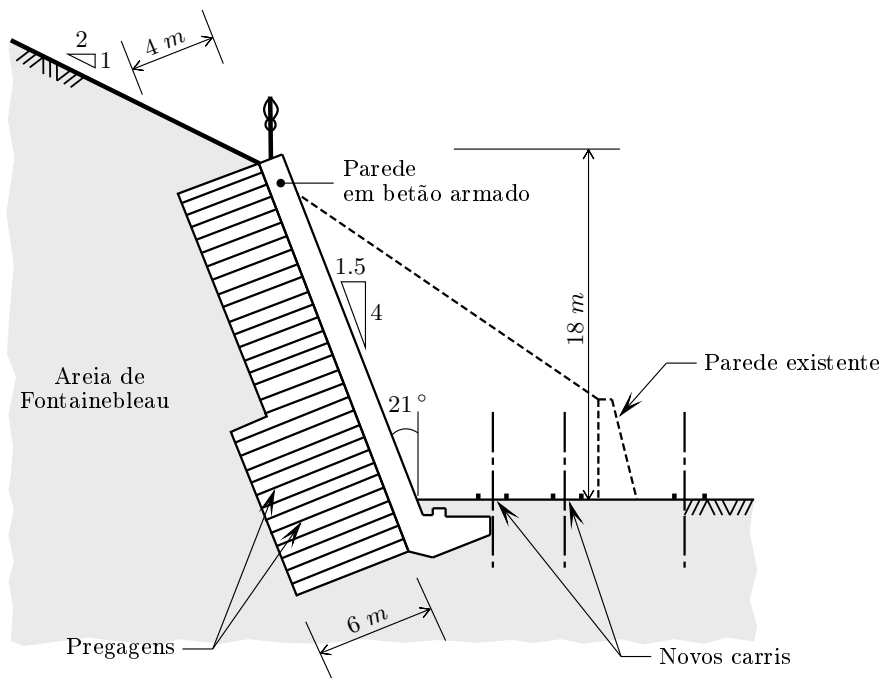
Secção transversal do muro de suporte de Versailles (adaptada de Rabejac e Toudic, 1974).
